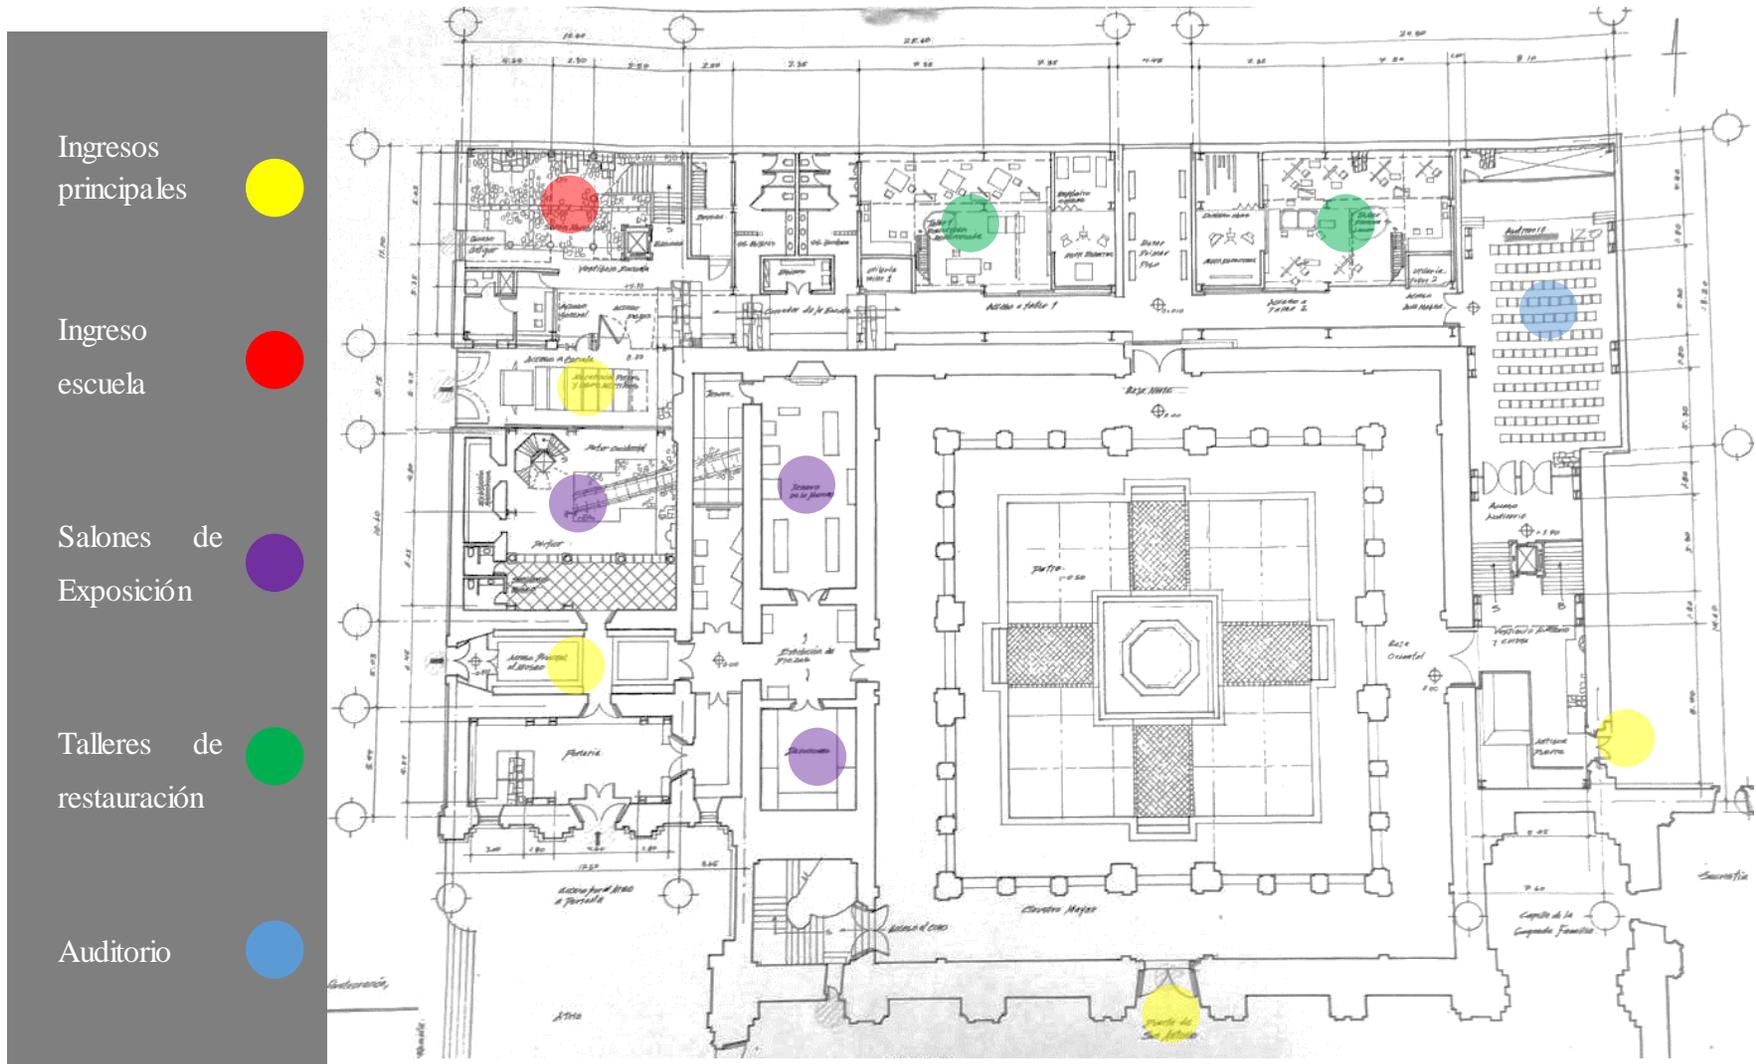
Planta baja, anteproyecto centro de restauración de bienes culturales religiosos. Fuente: Arq. Guillermo Aguirre
